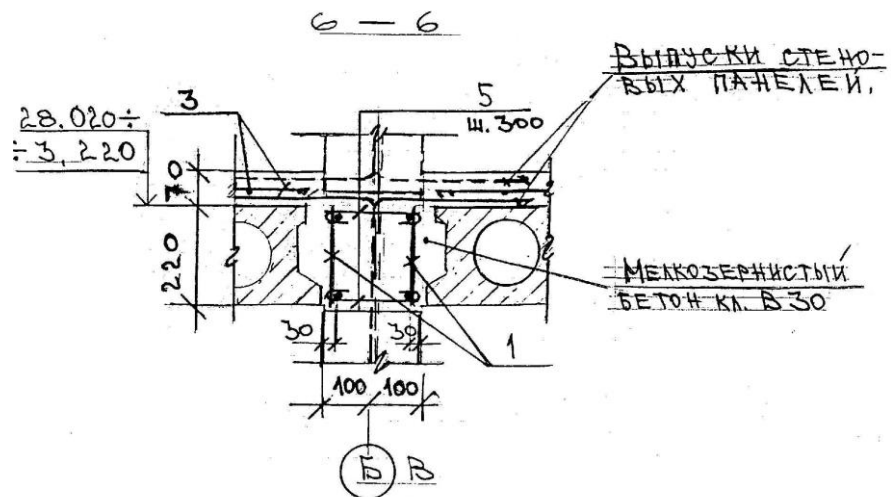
Примикання бокових поверхонь плит до внутрішньої стіни
